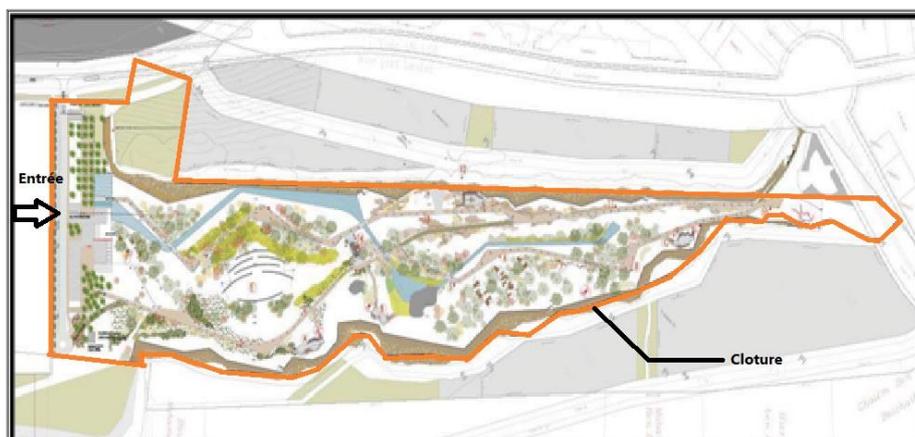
Plan général du projet de parc, document d'architecte (A. GHAZALI)
